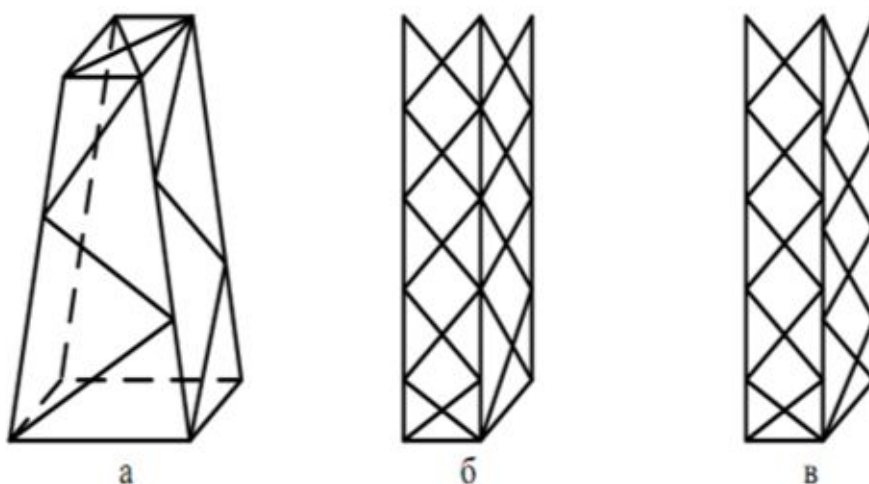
Ствол опоры с решеткой: а – «в елку»; б – с перекрестной решеткой; в – с перекрестной решеткой со смещением узлов в смежных гранях
